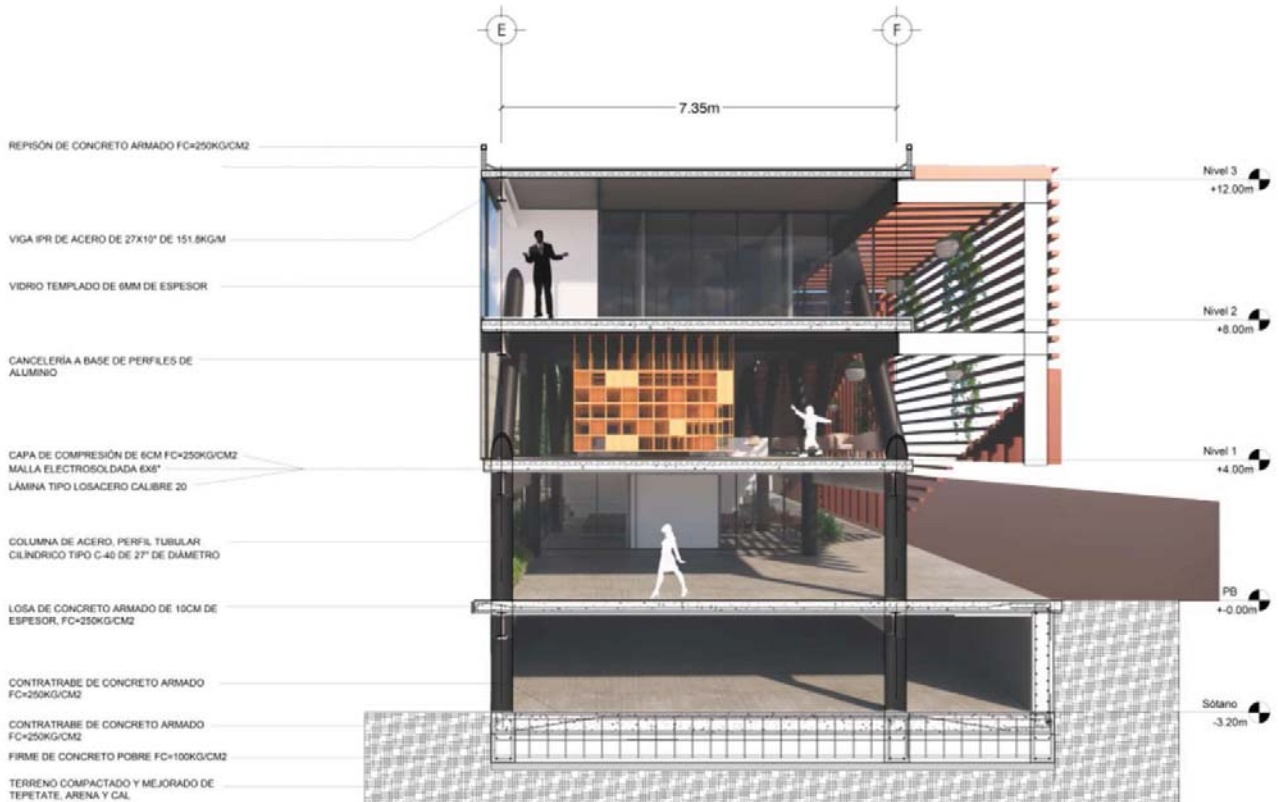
Corte por fachada biblioteca, [elaboración propia].
